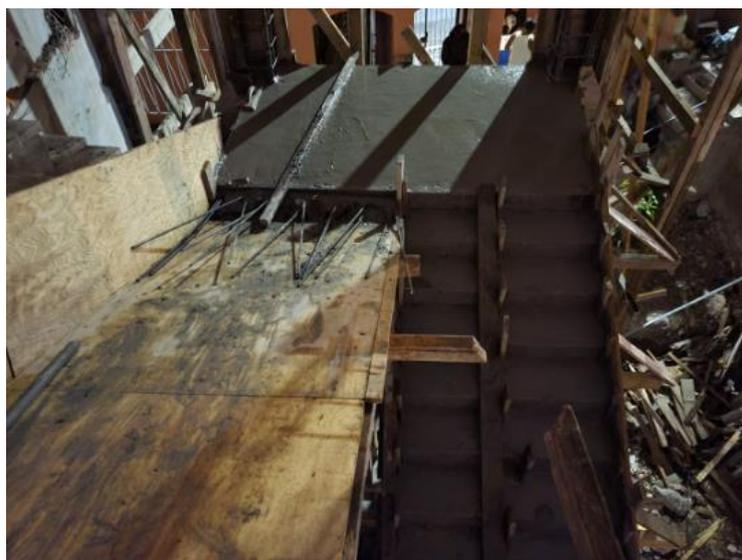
Vuelta en colocación de piloteado y acero de refuerzo
